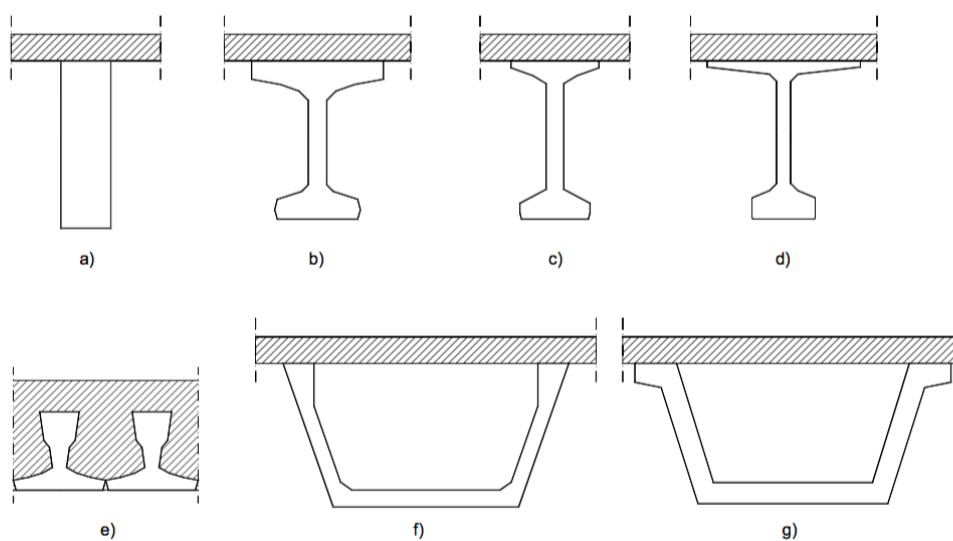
Tipos de secções de vigas pré-fabricadas correntemente utilizados (adaptado de Calavera Ruiz e Hernández (2002)).
